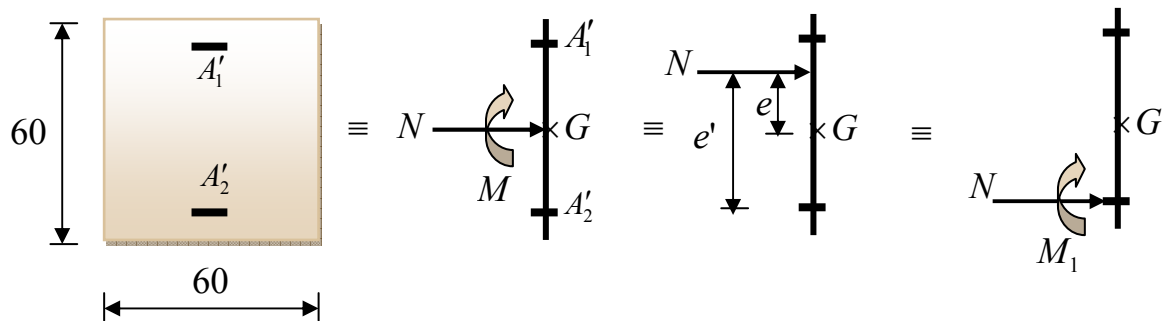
Position de N_1 et M_1 sur la section transversale.
